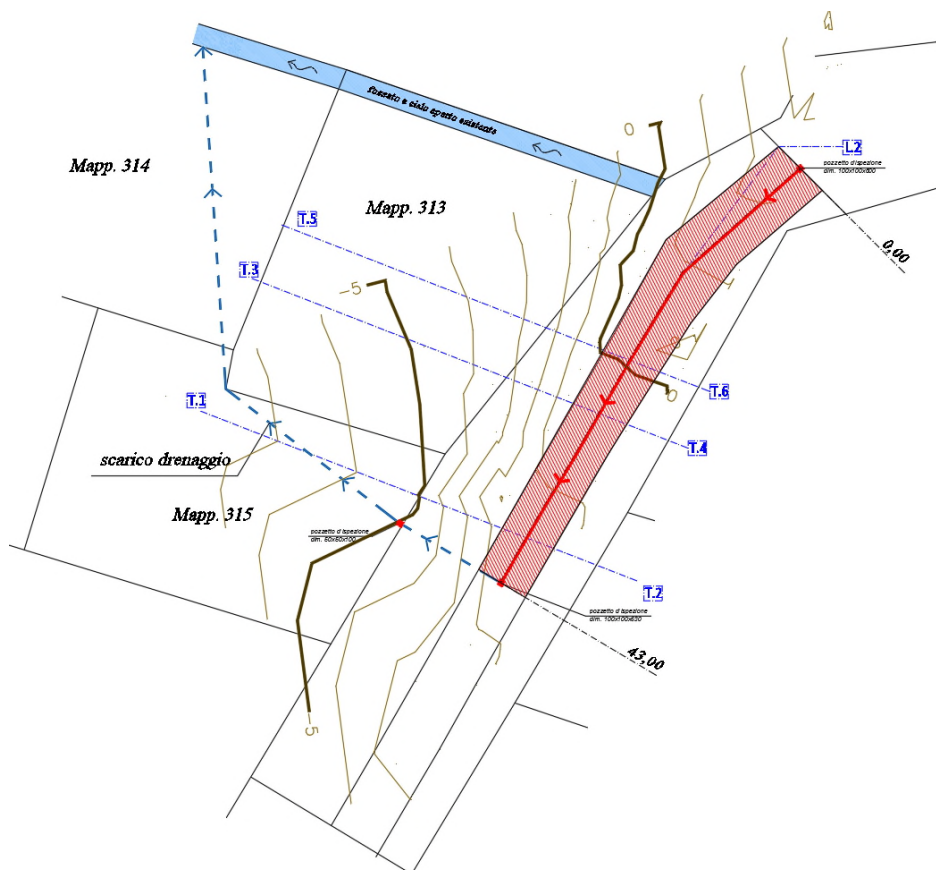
planimetria dell'intervento in via Vittorio Veneto e relativo sistema di scarico al ricettore finale
